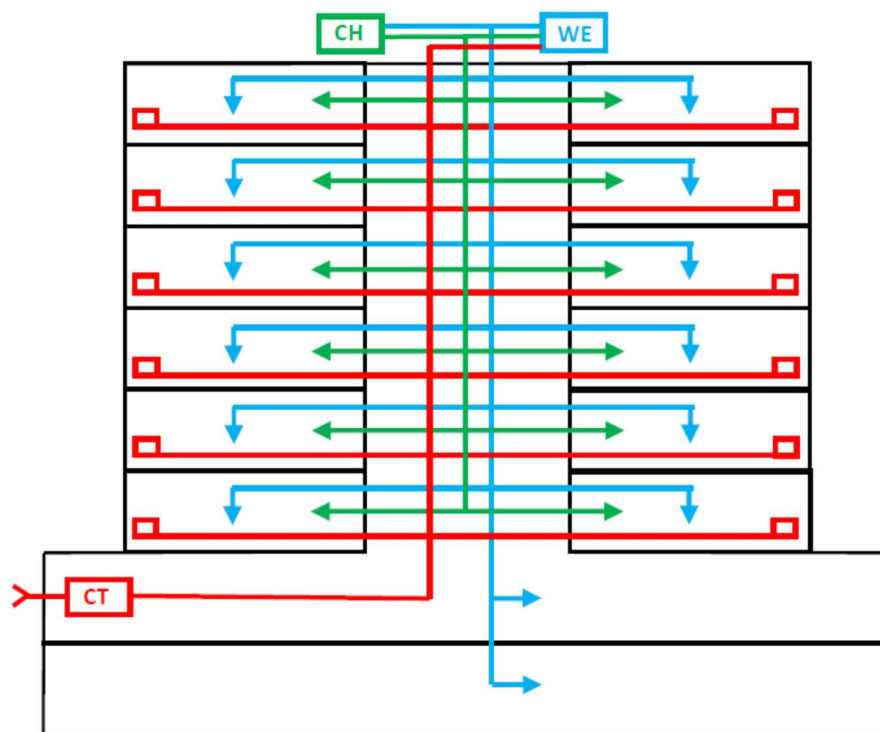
Schemat instalacji w maszynie dachowej
